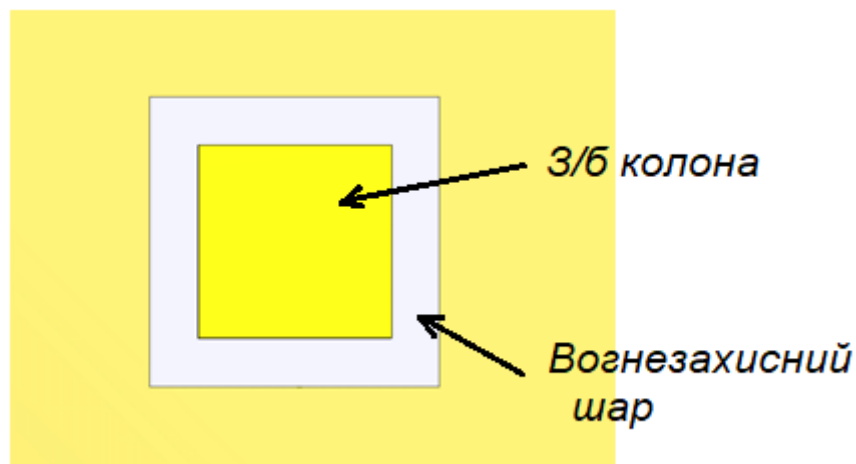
Поперечного перерізу залізобетонної колони з нанесеним вогнезахисним шаром
